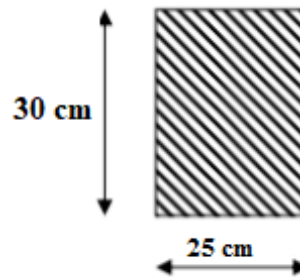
Coupe verticale d'une Poutre Chaînage.
